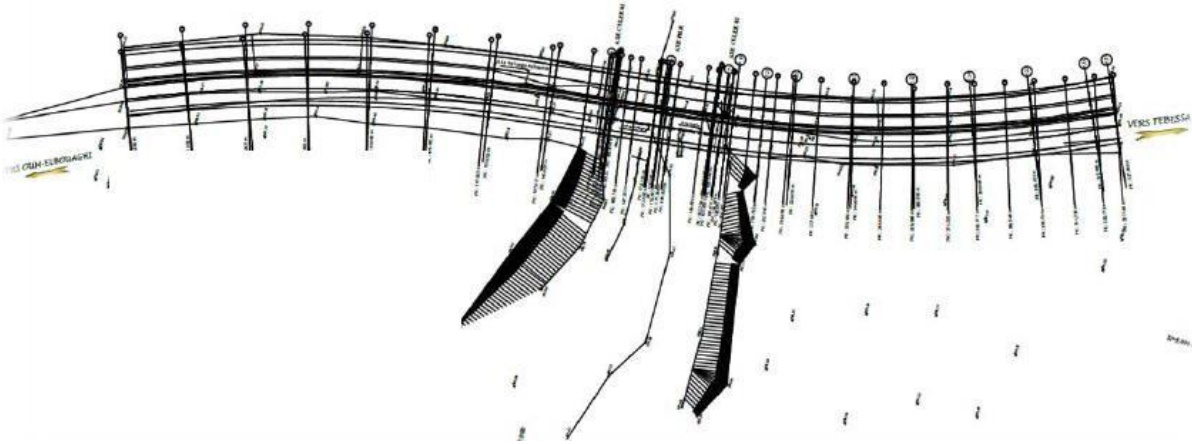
Vue en plan du pont sur oued Hamadja
